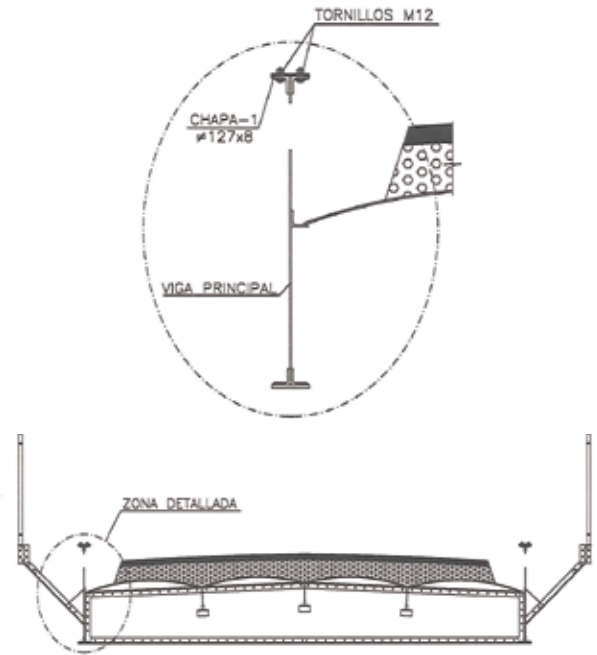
Fase 2: colocación de la chapa de refuerzo sobre la viga principal
